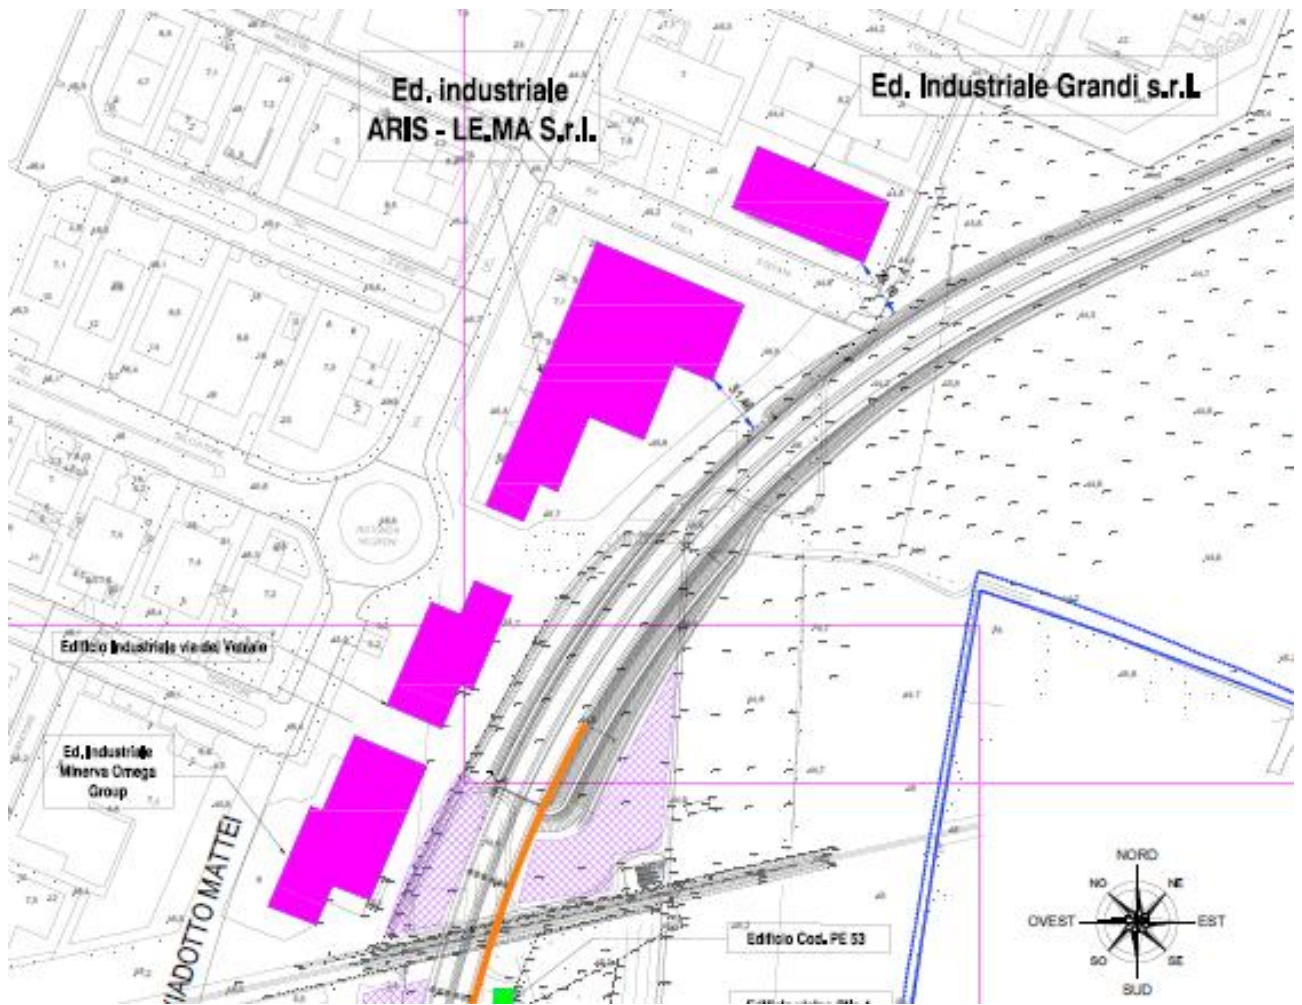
Stralcio del rilevato di nuova costruzione tra la Spalla B e il rilevato Nord con relativi edifici industriali oggetto di monitoraggio.
